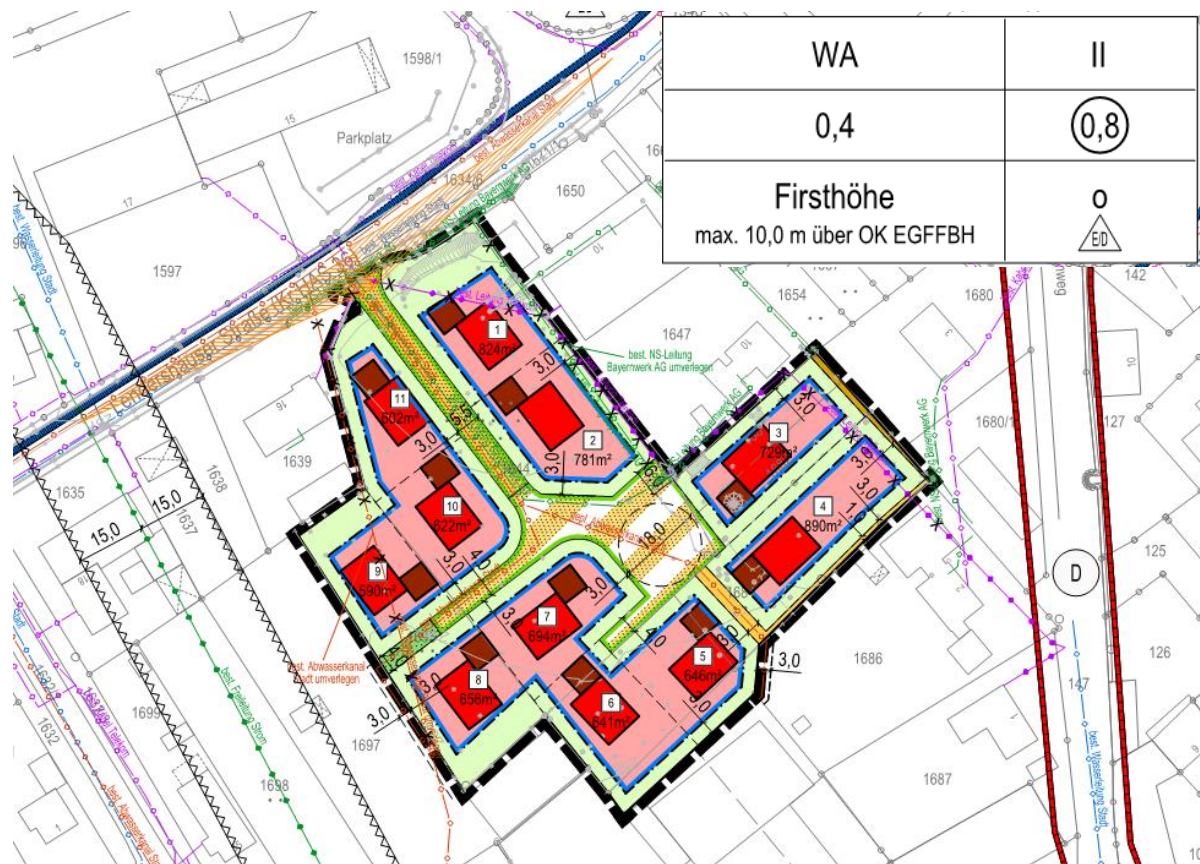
Bebauungsplan „Lendershäuser Straße“, Planteil mit Nutzungsschablone
